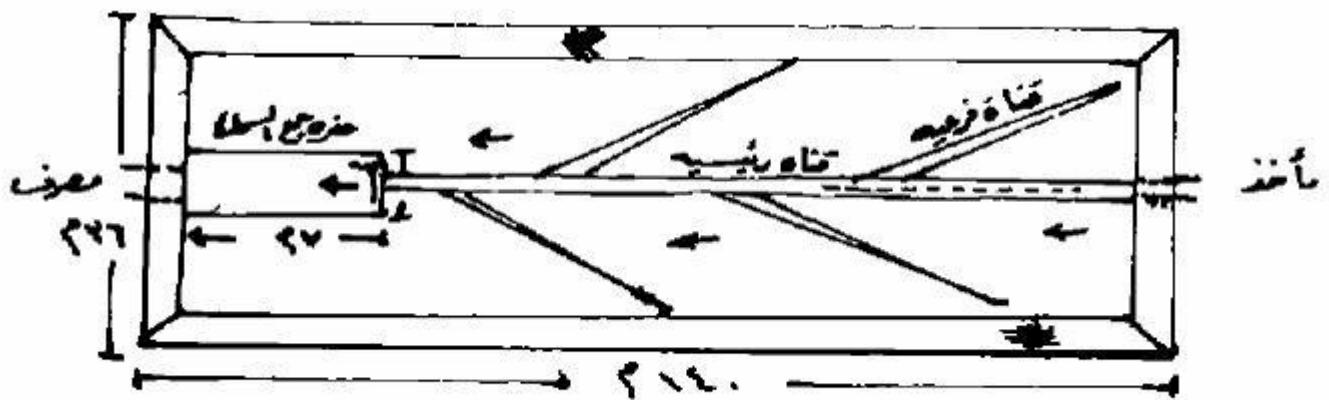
مسقط أفقي لخوض تسمين أسماك كارب ومشط
